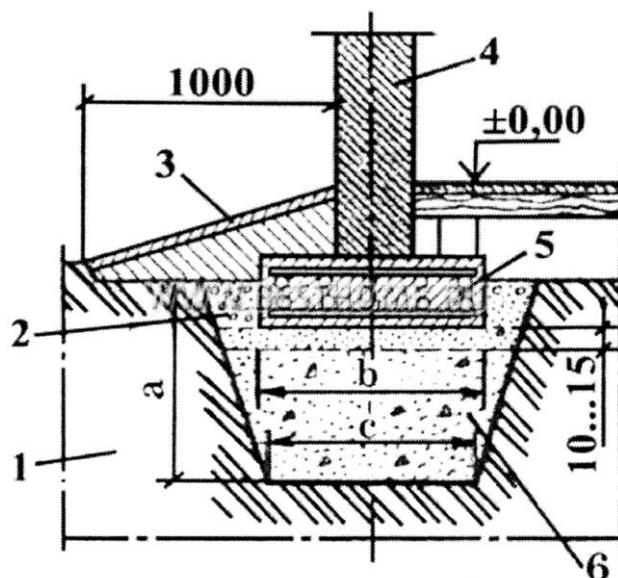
Конструкция незаглубленного фундамента: 1 - материковый грунт; 2 - засыпной грунт (гравий, щебень, песок); 3 - отмостка; 4 - стена дома; 5 – фундамент - железобетонная постелистая плита; 6-утрамбованный грунт с песчаной подушкой толщиной 10-15 см; а, b, с - размеры по месту
